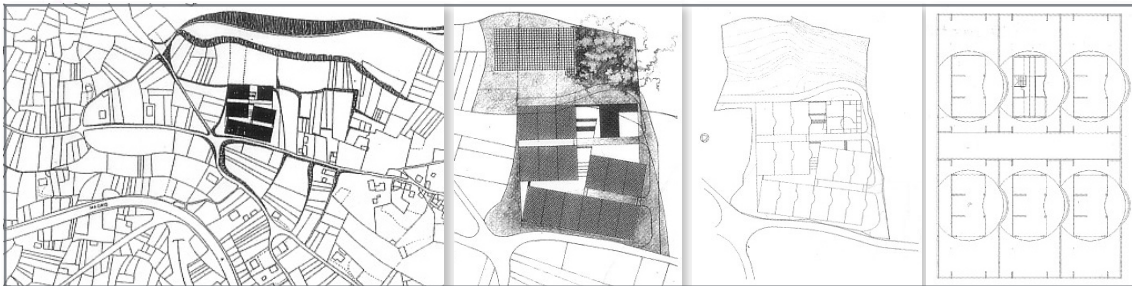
Plantas Generales: Planta de situación y parcelario. Esquema de ordenación. Planta general de ordenación. Trama reguladora. Fuente: Revista Obradoiro N°18 (1991)
